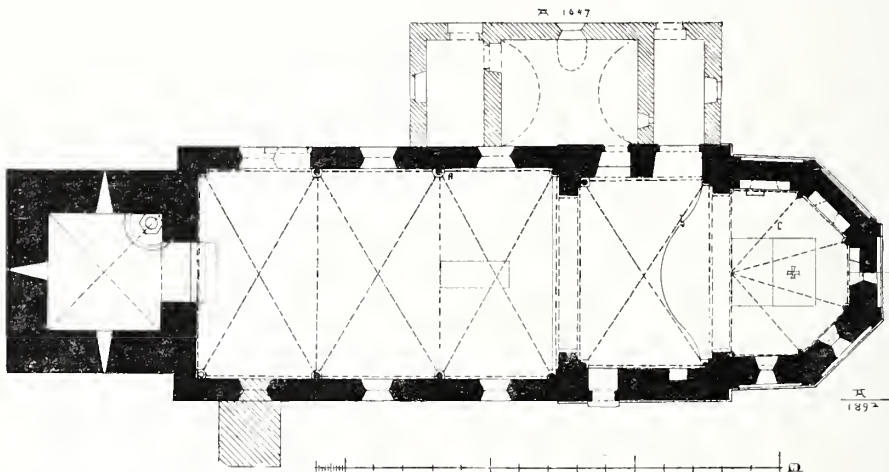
Lüftelberg Kathol. Pfarrkirche. Grundriss.
